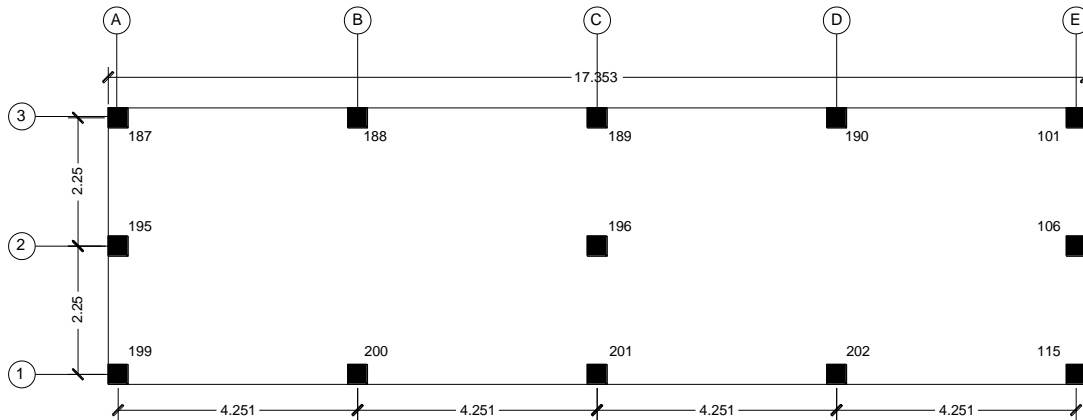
Elementos de columnas en Sección inclinada
